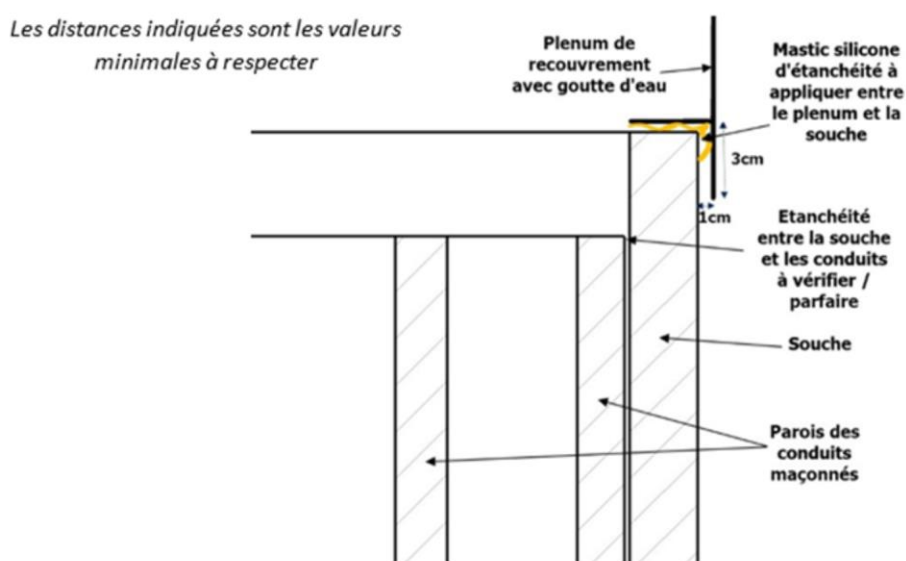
Coupe verticale d'un plenum de recouvrement sur souche avec dalle retirée
